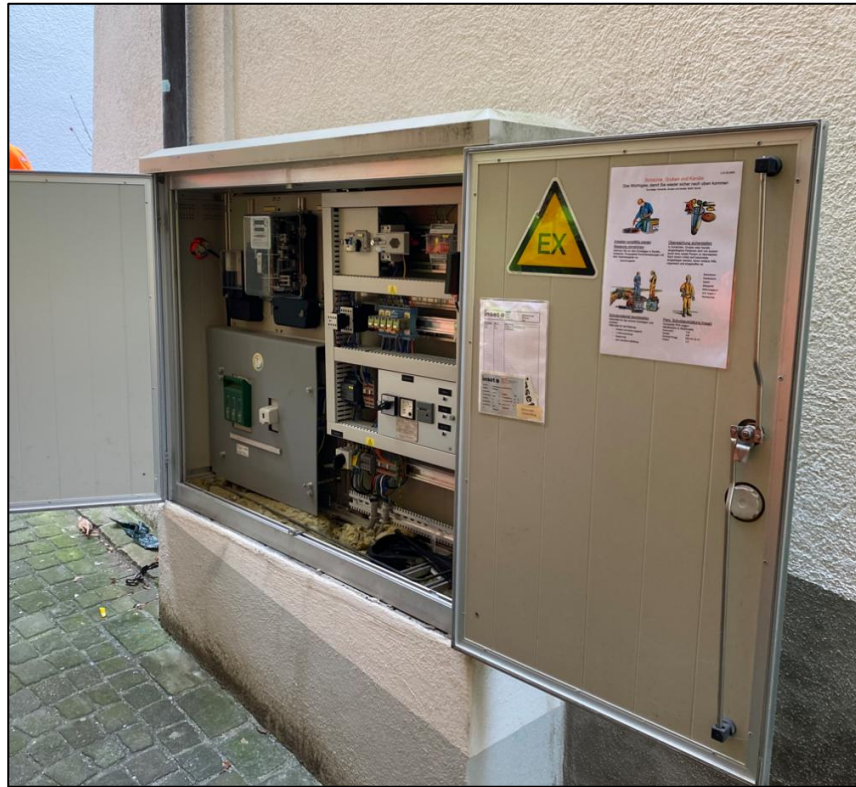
Ansicht Aussenkabine mit Zähler EVU und Steuerungstechnik
